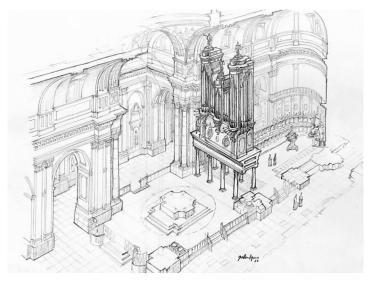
Sección esquemática del coro bajo de catedral. Se observa la tribuna en la que se construyó el órgano en 1803. Dib. Guillermo Aguirre.
